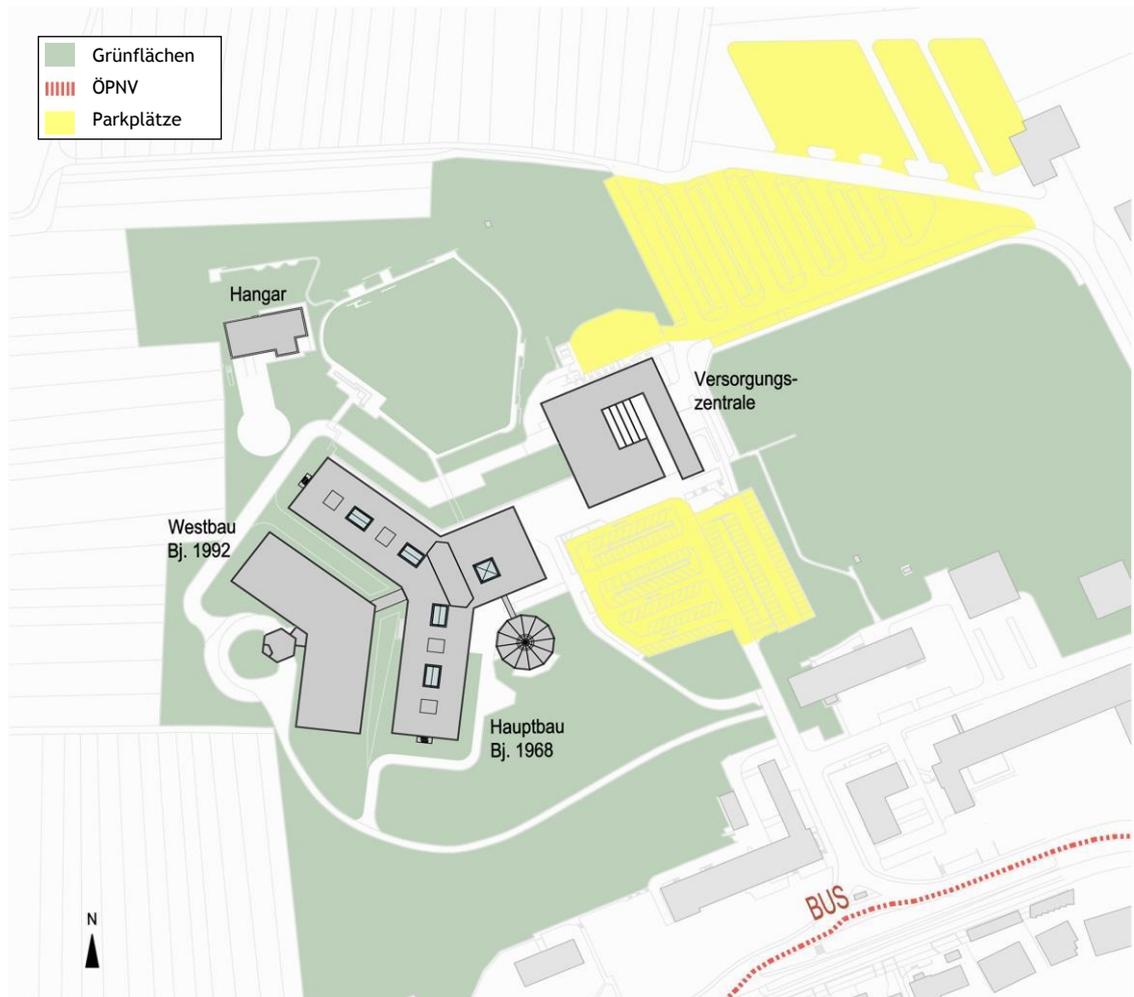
Lageplan mit Grünflächen, ÖPNV und Parkplätzen
